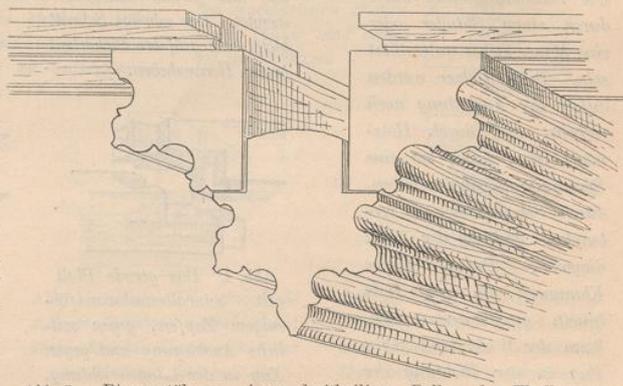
Birnenstäbe an einem dreitheiligen Balken des Thalhauses in Halle a. S.; 16. Jahrhundert.
